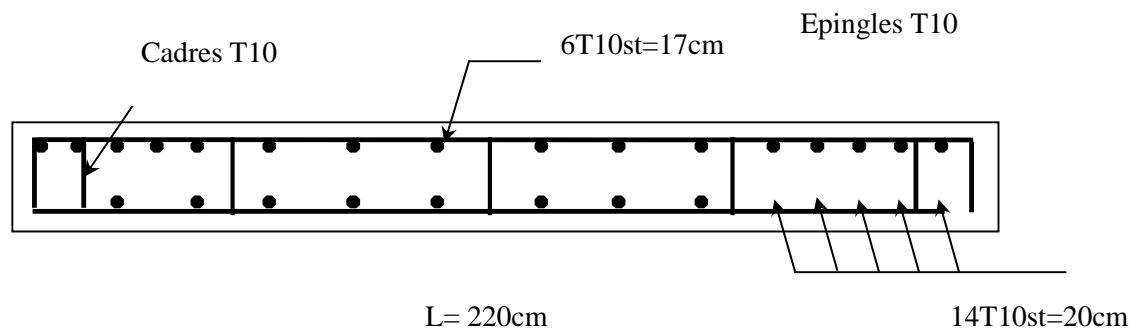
Schéma de ferrailage du voile 1 /ox au niveau de RDC.
